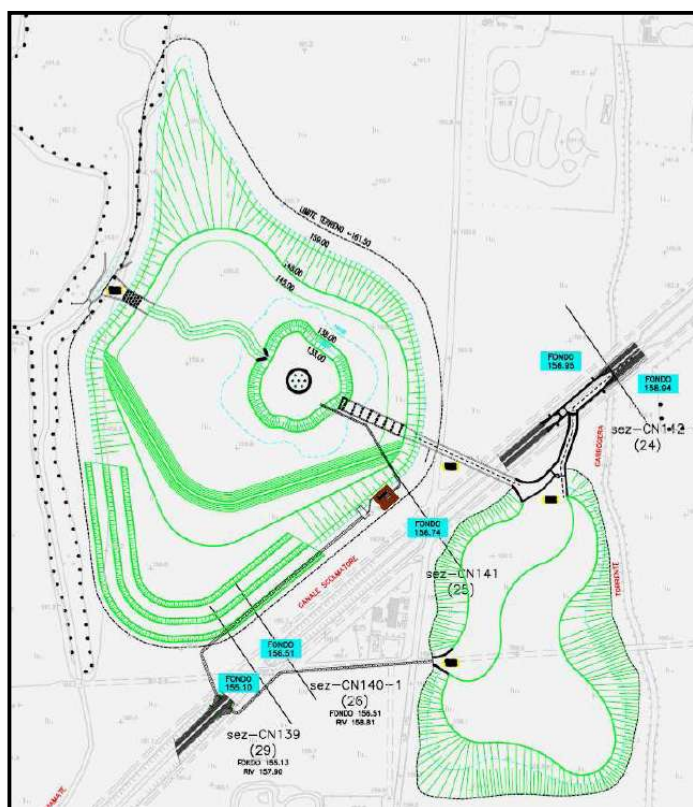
Configurazione planimetrica dell'invaso di laminazione a Senago (studio idraulico ETATEC s.r.l.).
